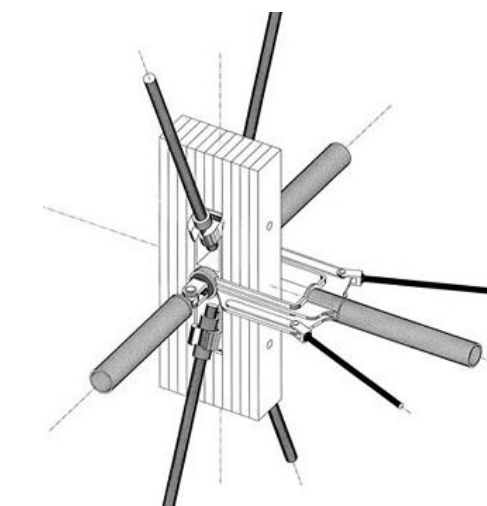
Viga laminada que recibe tubos horizontales y barras tirantes diagonales de acero inoxidable. Pinterest (s.f.).
